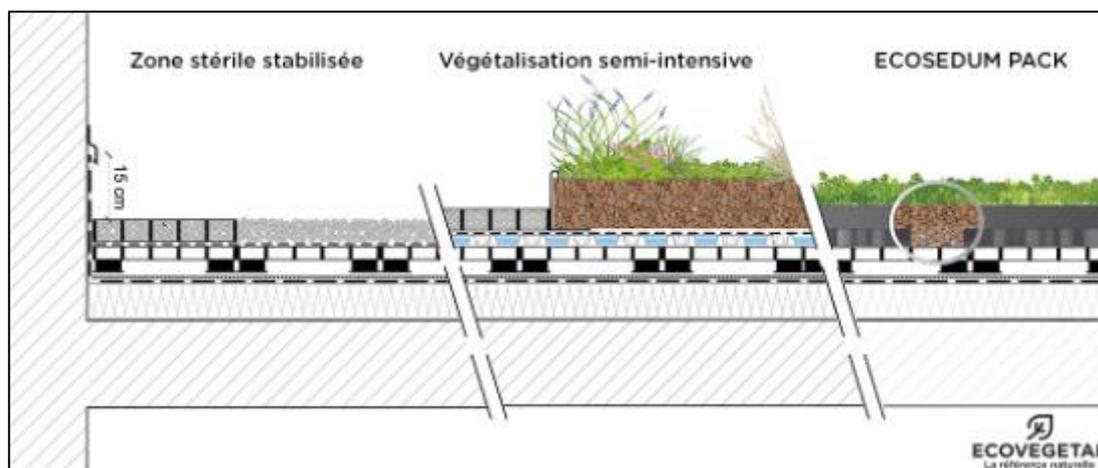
Toiture terrasse non accessible pour la retenue temporaire des eaux pluviales
